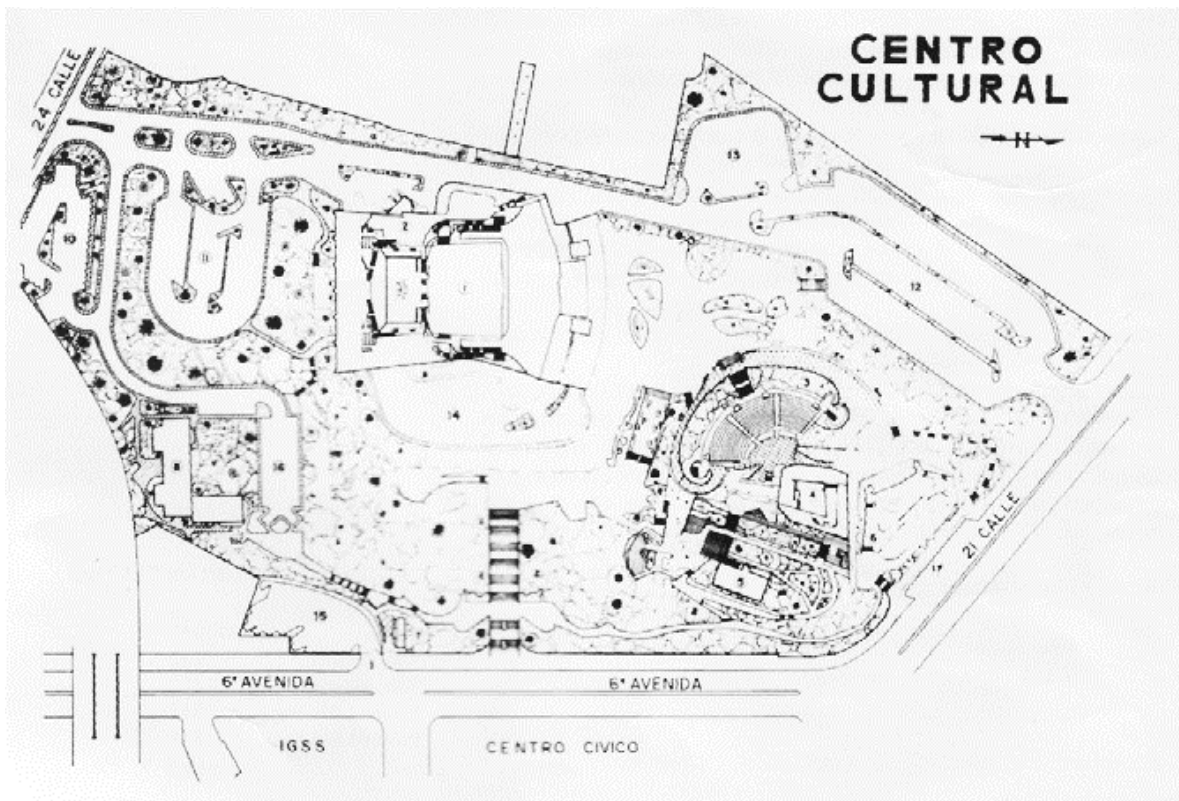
Planta de conjunto y ubicación Teatro Nacional. Foto: Revista Información Técnica Teatro Nacional.
